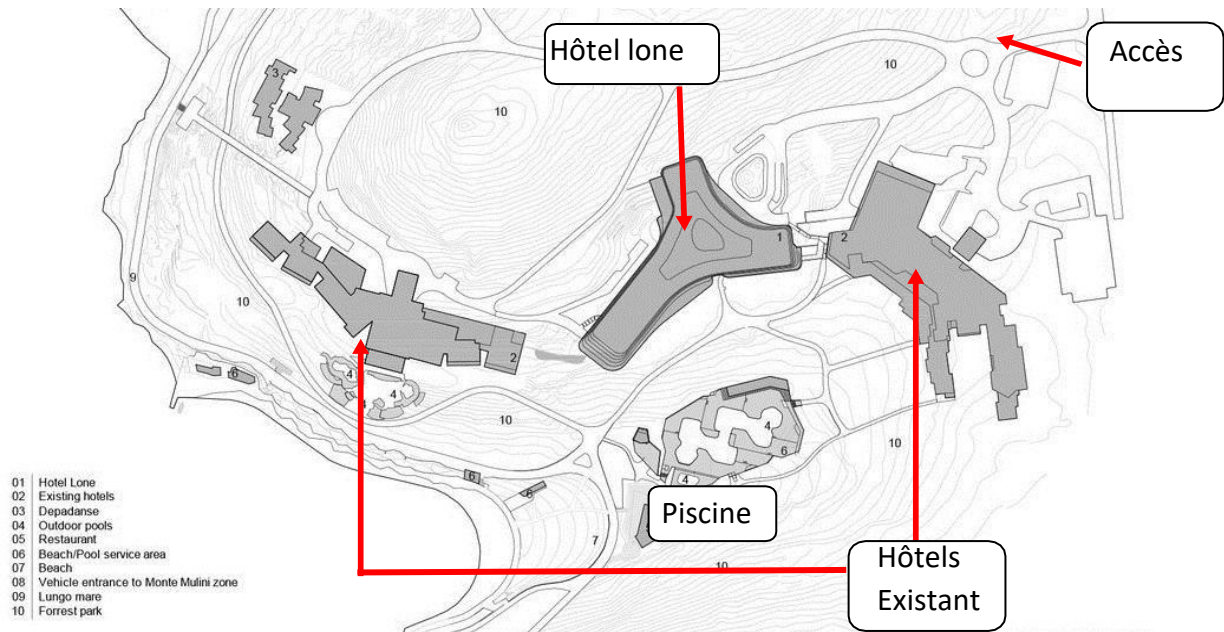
PLAN DE MASSE HOTEL LONE Source: <http://www.architecturenewsplus.com/cdn/images/1/n/2/8/n28kljz.jpg>
